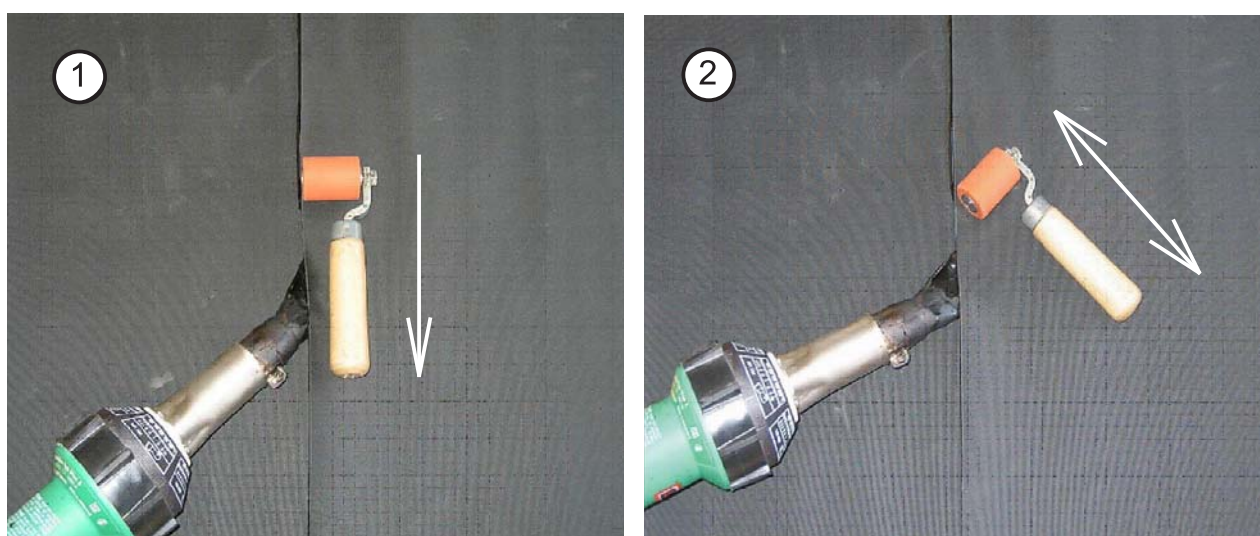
Варианты расположения прикаточного ролика и сопла при сварке ручным аппаратом;
